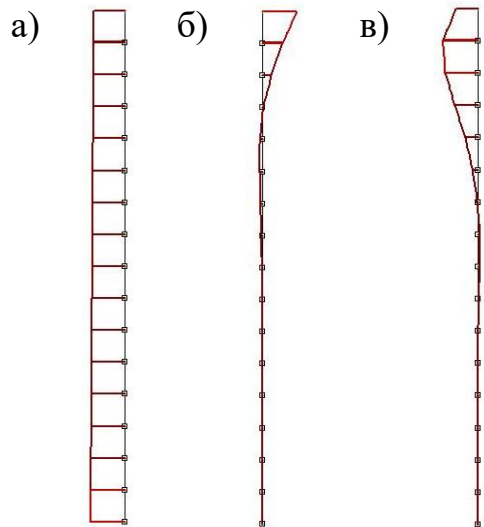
Площа арматури на 1 пм по осі Y у верхньої грані
